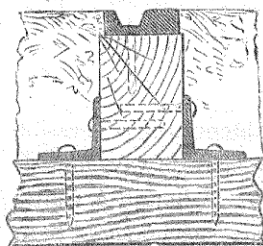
Tramway de la ville de Wellington. Section du rail etc. Échelle 1/8.
